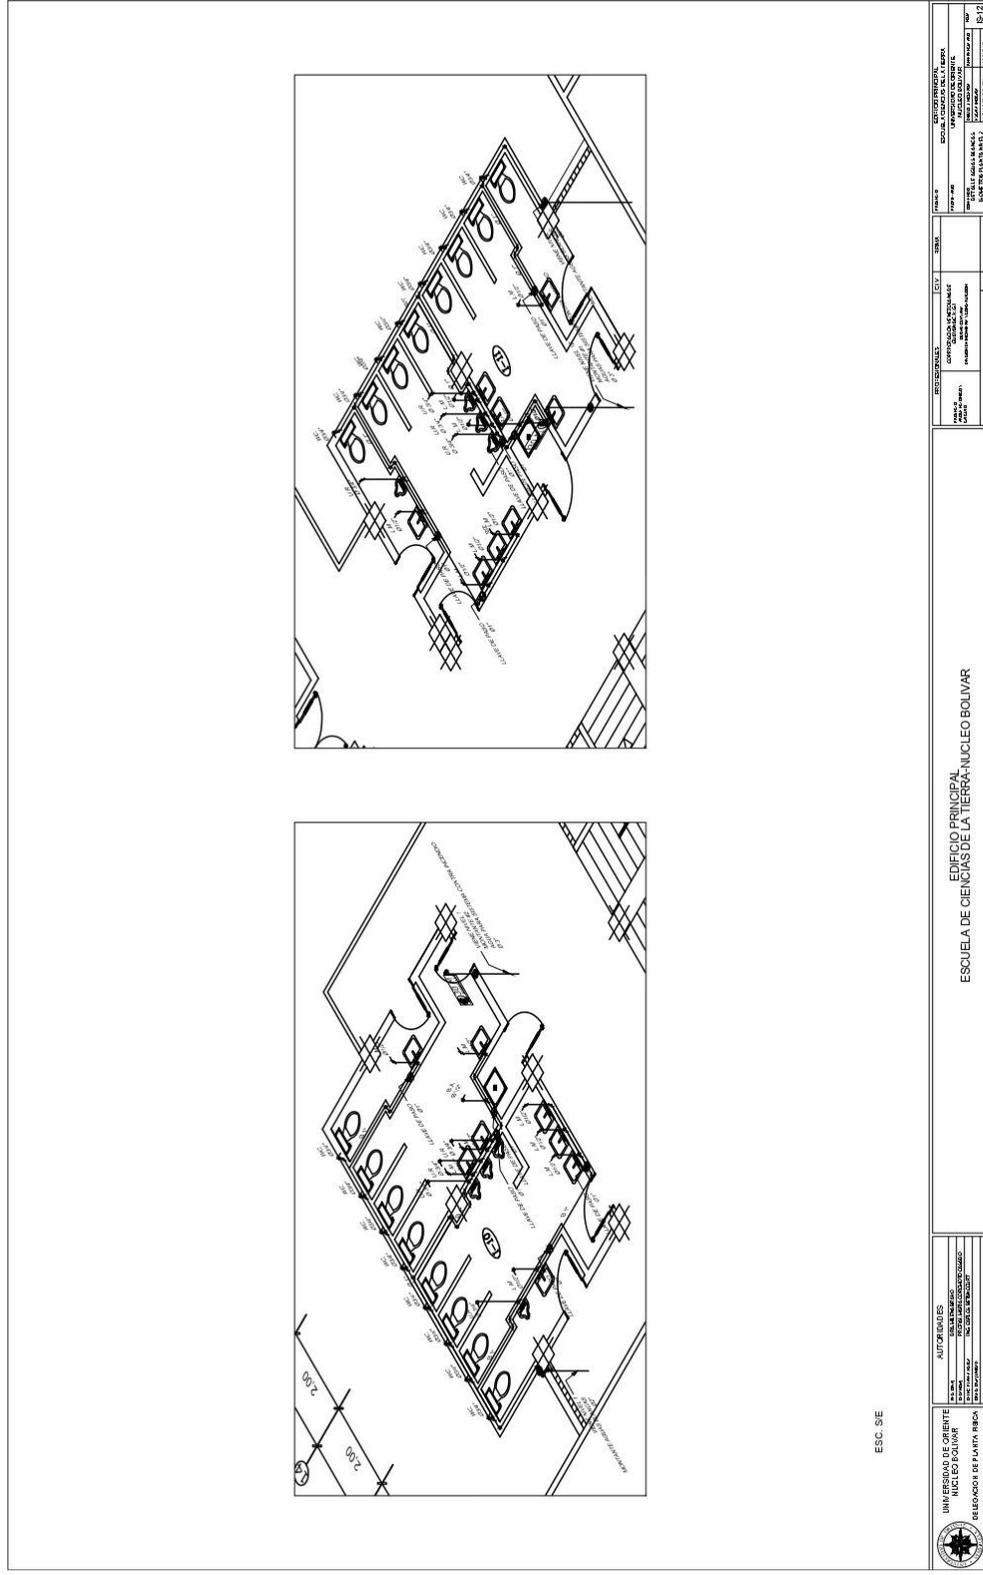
Detalle Aguas Blancas Isometría Planta Nivel 2
